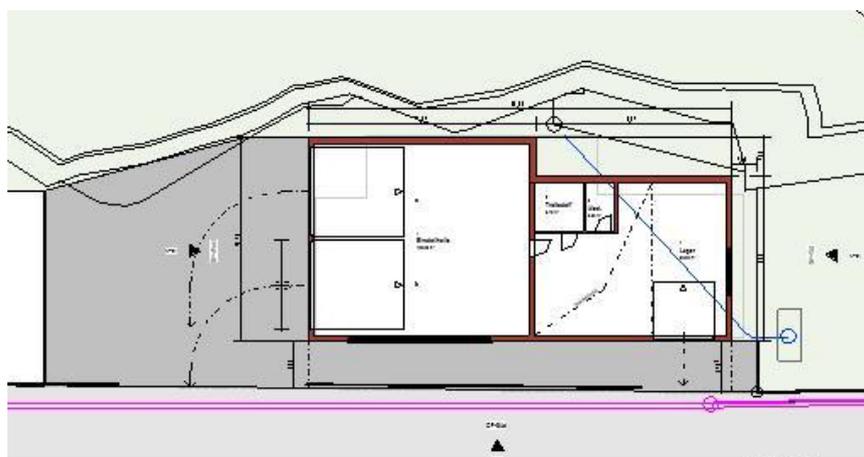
Situationsplan neuer Holzschopf Bündelti
